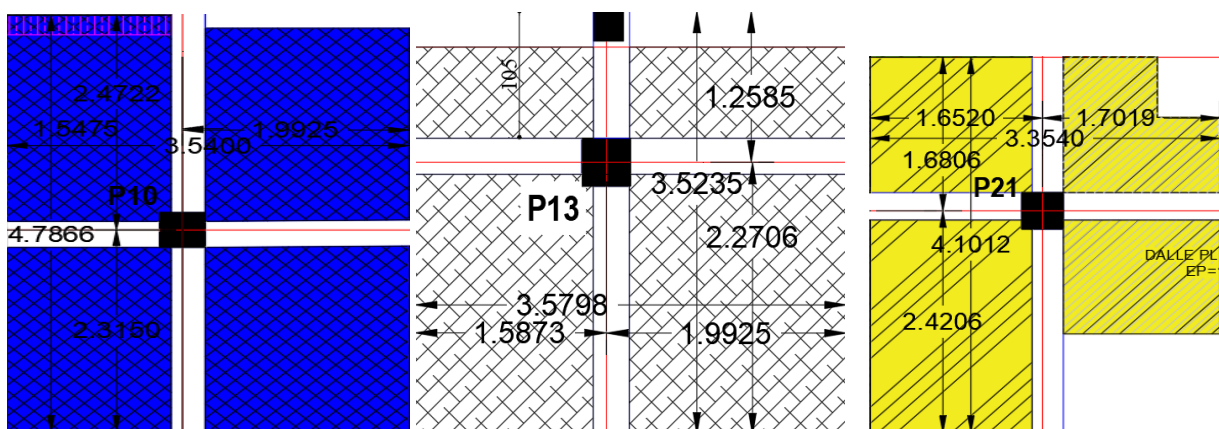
Vue en plan des surfaces revenant aux poteaux centraux, poteaux de rive et poteaux d'angle respectivement.
